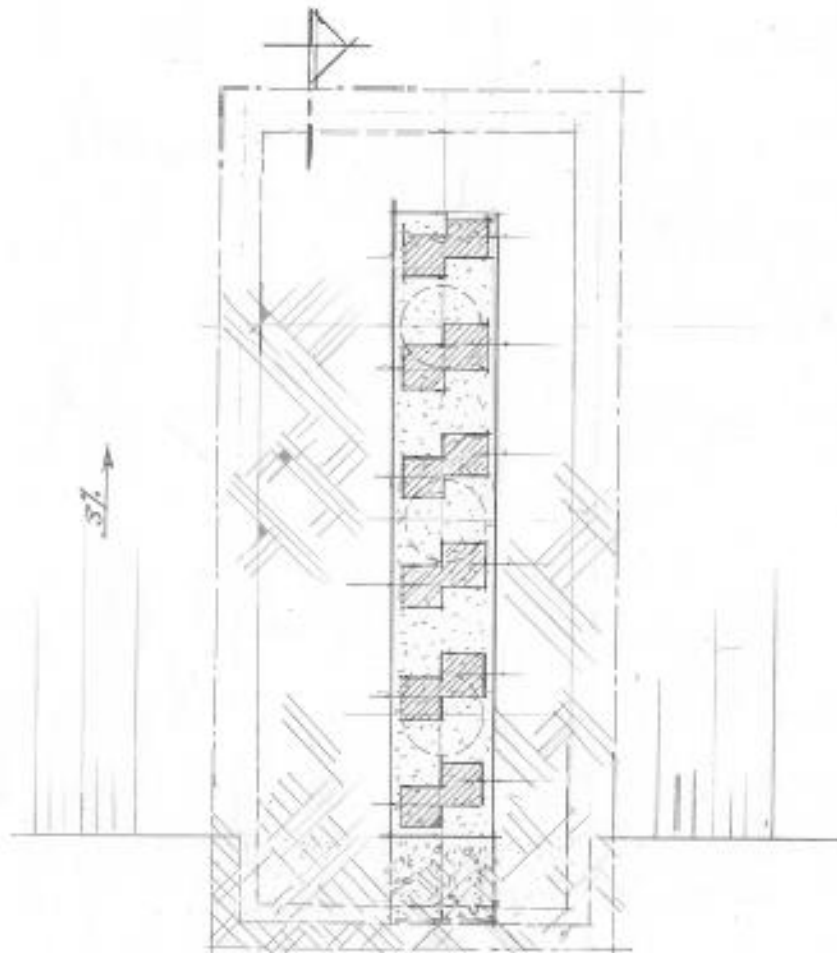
ENCOFRADO EN VOLADIZO - INSTALACIÓN
